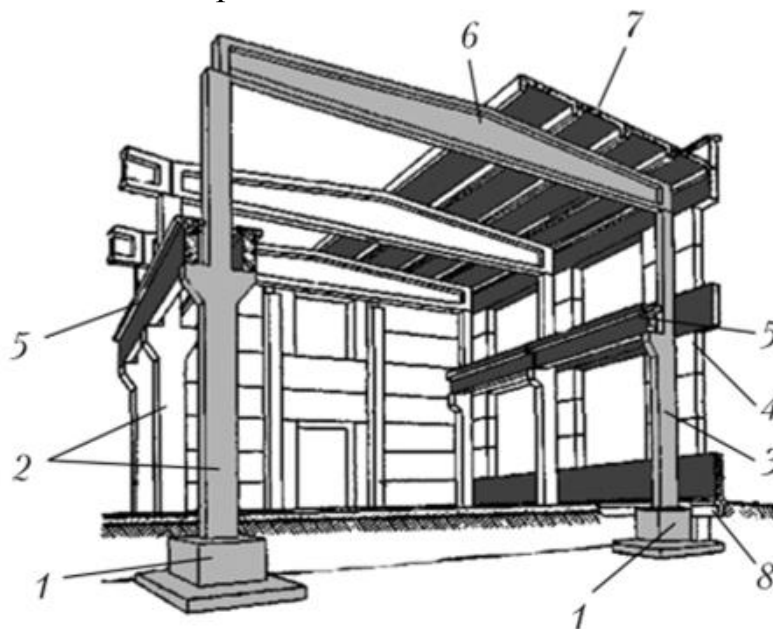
Конструкции одноэтажного железобетонного промышленного здания: 1 – столбчатый фундамент стаканного типа, 2 – колонны среднего ряда, 3 – колонна крайнего ряда, 4 – стеновые панели, 5 – подкрановые балки, 6 – балка покрытия, 7 – ребристые плиты покрытия, 8 – фундаментная балка
